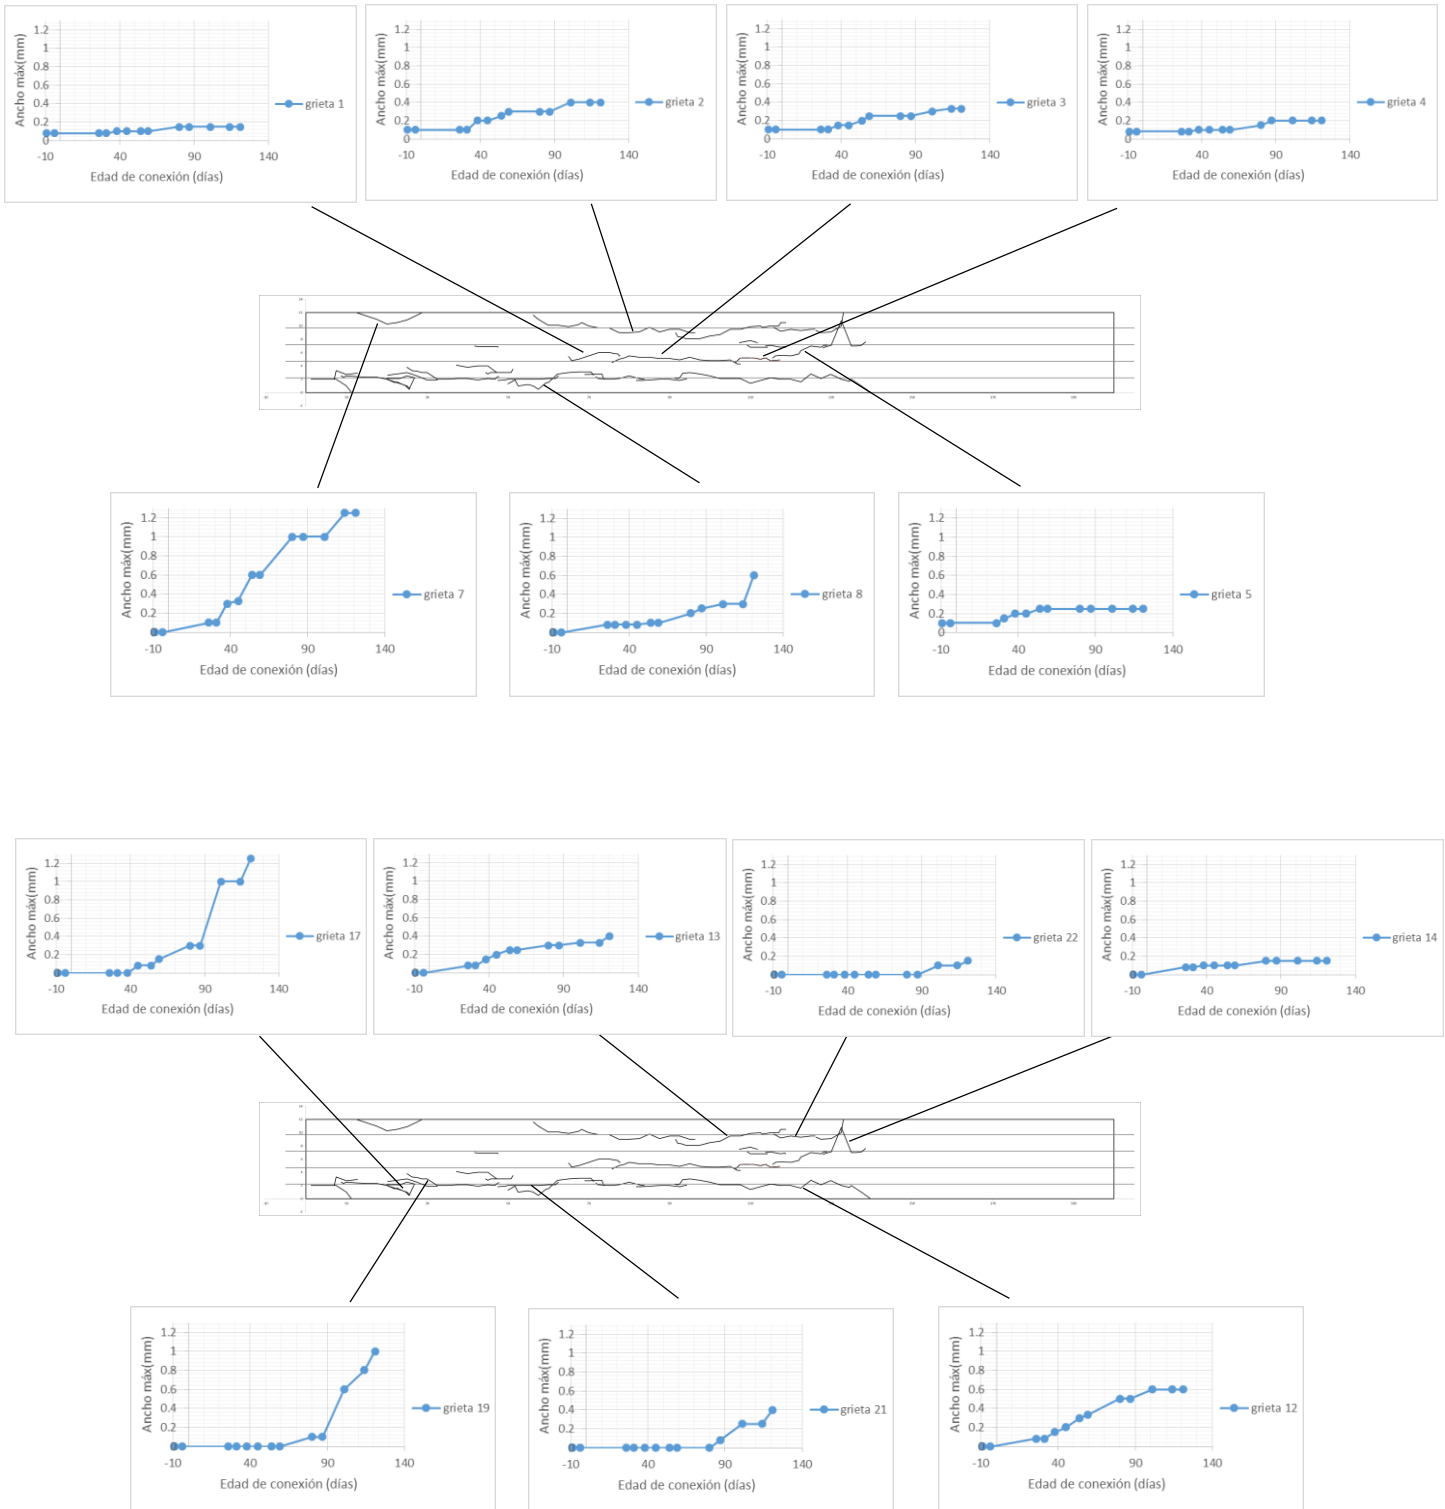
Localización y ancho máximo de grieta viga VCPC4.
